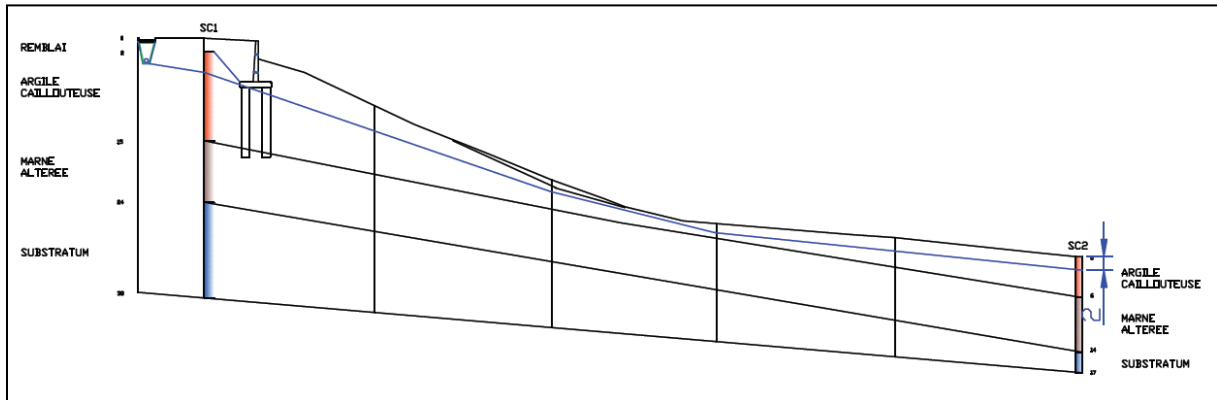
Profil du talus légèrement reprofilé avec un mur de soutènement
